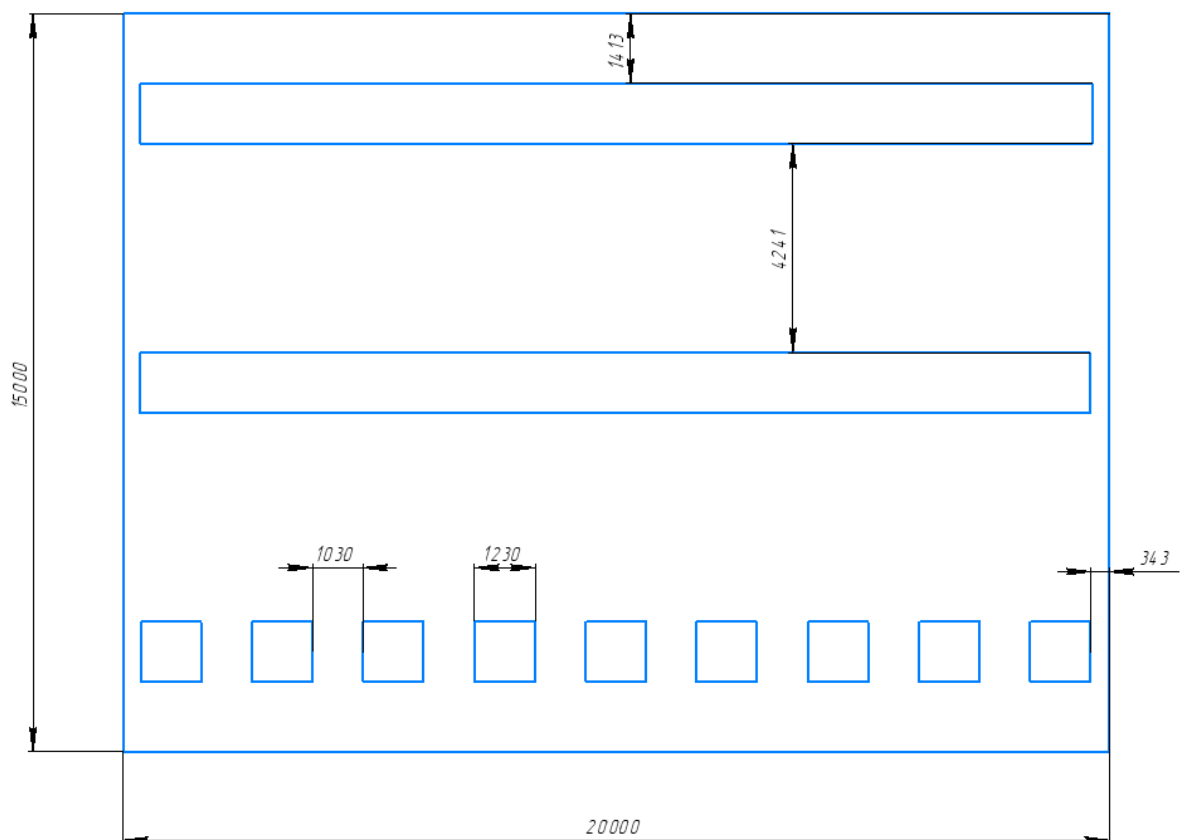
План помещения и размещения светильников с люминесцентными лампами
